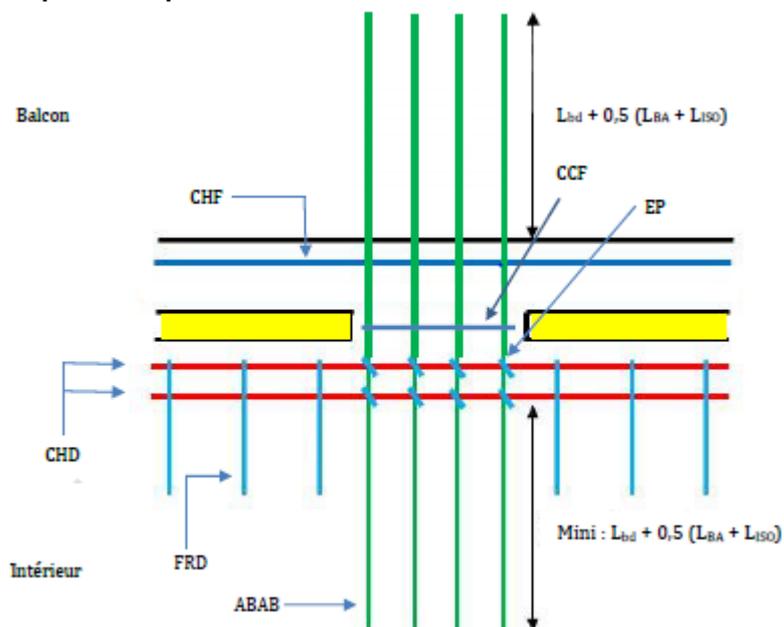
Exemple de dispositions constructives au droit d'un isolant en zone de balcons
